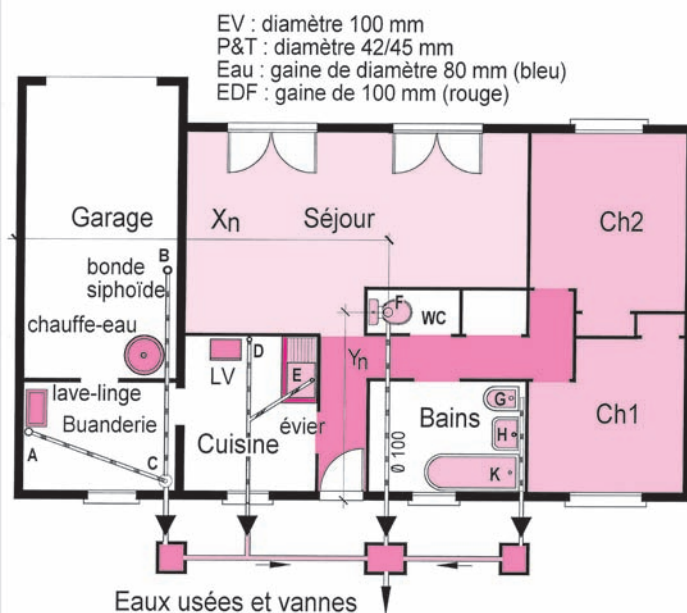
Schéma de principe d'un réseau EU et EV sous dallage
